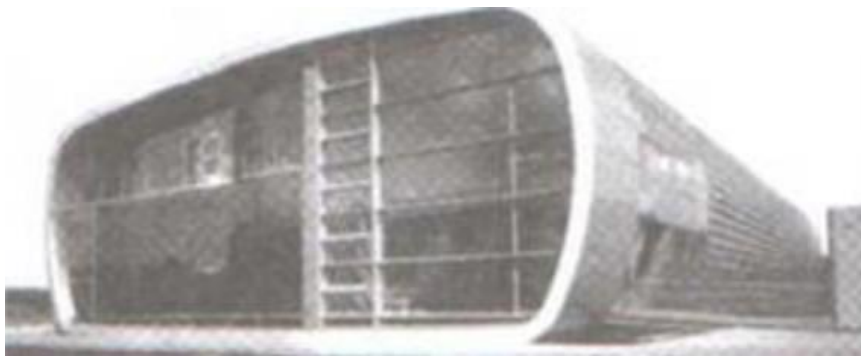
Формування криволінійних будівель на основі монолітного залізобетону (по методу переставної опалубки)
